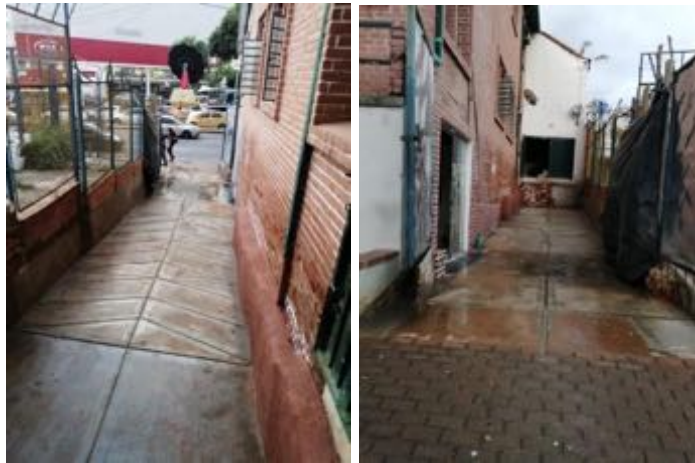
Fundida de concreto para Rampa de Acceso (Fuente propia)
